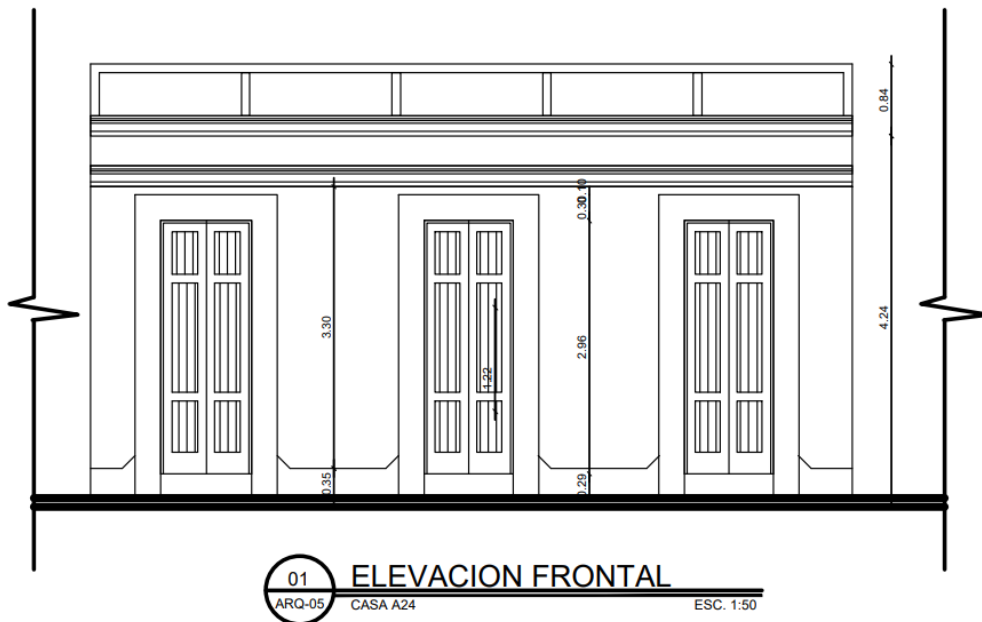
ELEVACIÓN FACHADA FRONTAL
